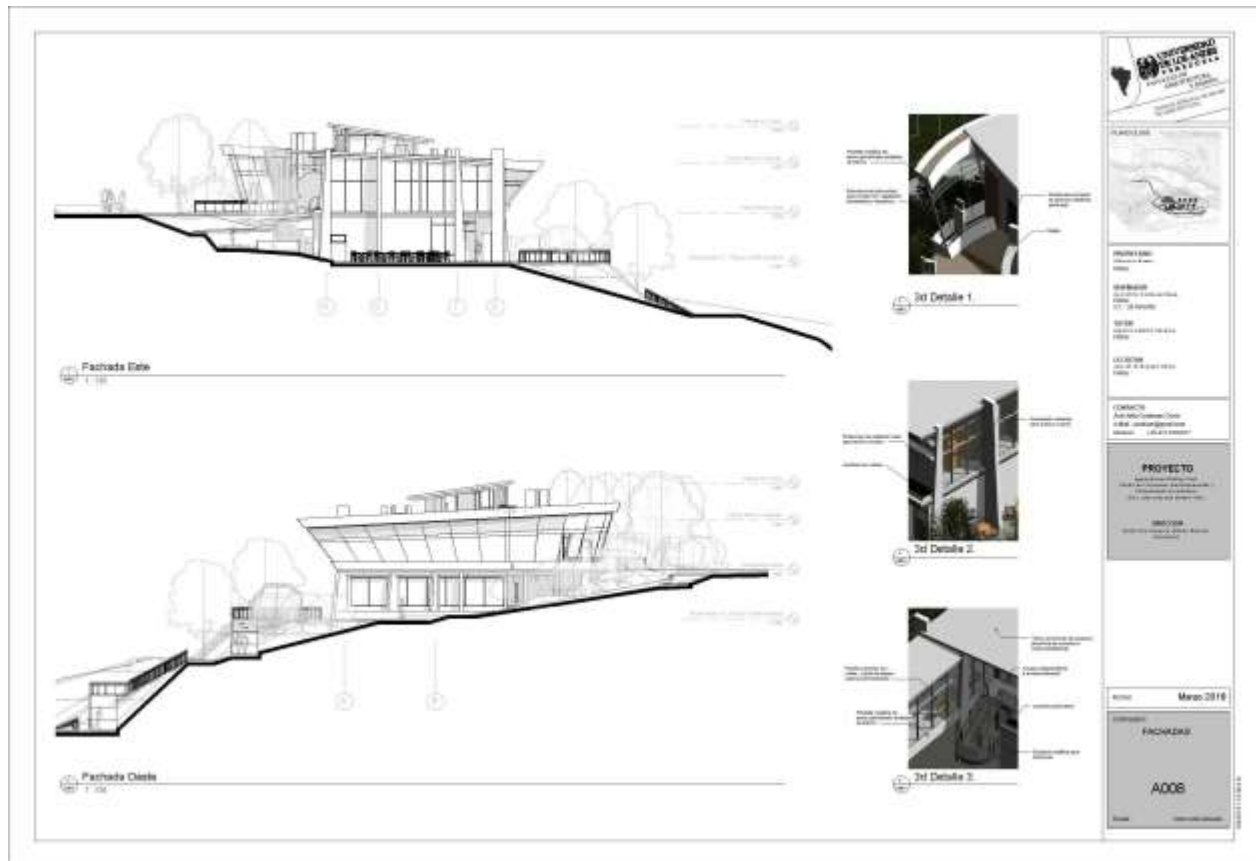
Fachadas Este, Oeste y detalles exteriores.
